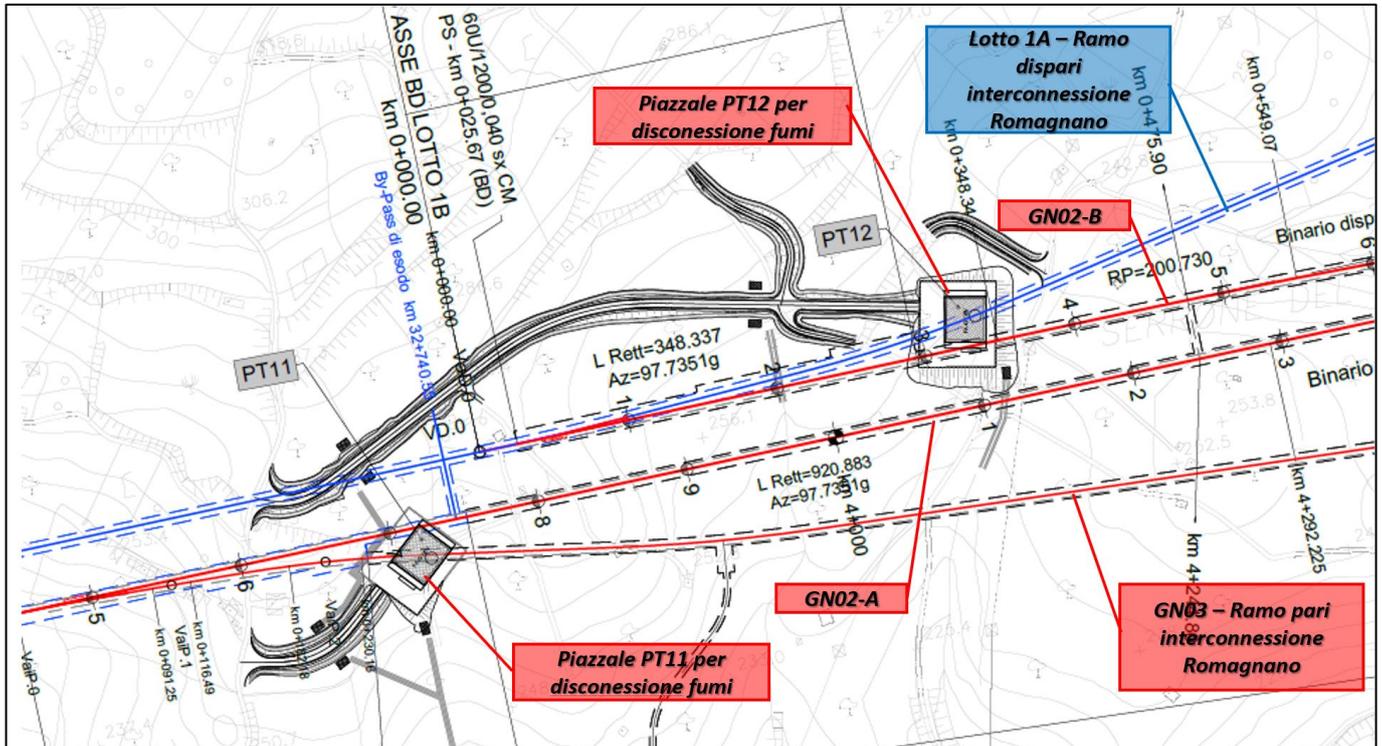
Stralcio planimetrico con individuazione piazzali disconnessione fumi
